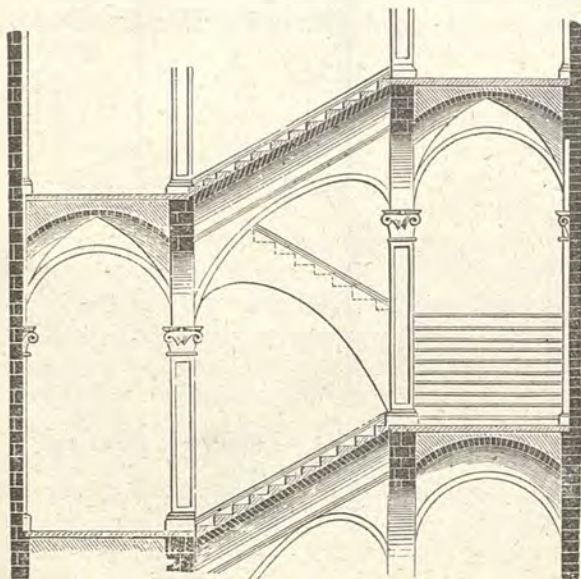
Scala con rampe sostenute da fianchi ad arco, vòlte a botte e pilastri.
